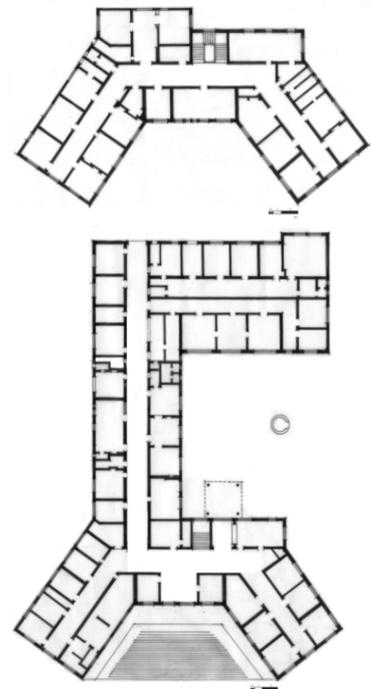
Casa de Saúde Dr. Mário Araújo. Plantas baixas térreo e superior.
